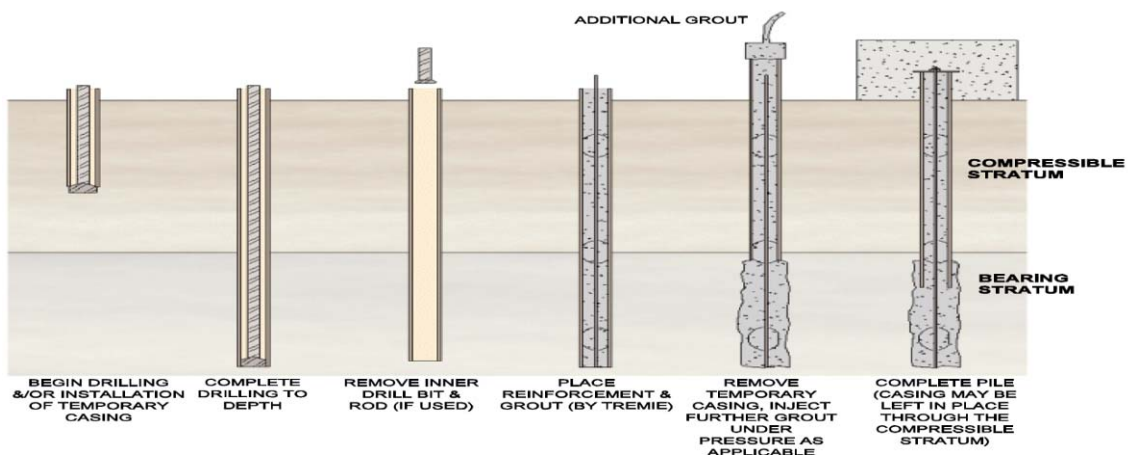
米国のマイクロパイルの施工方法³⁾
